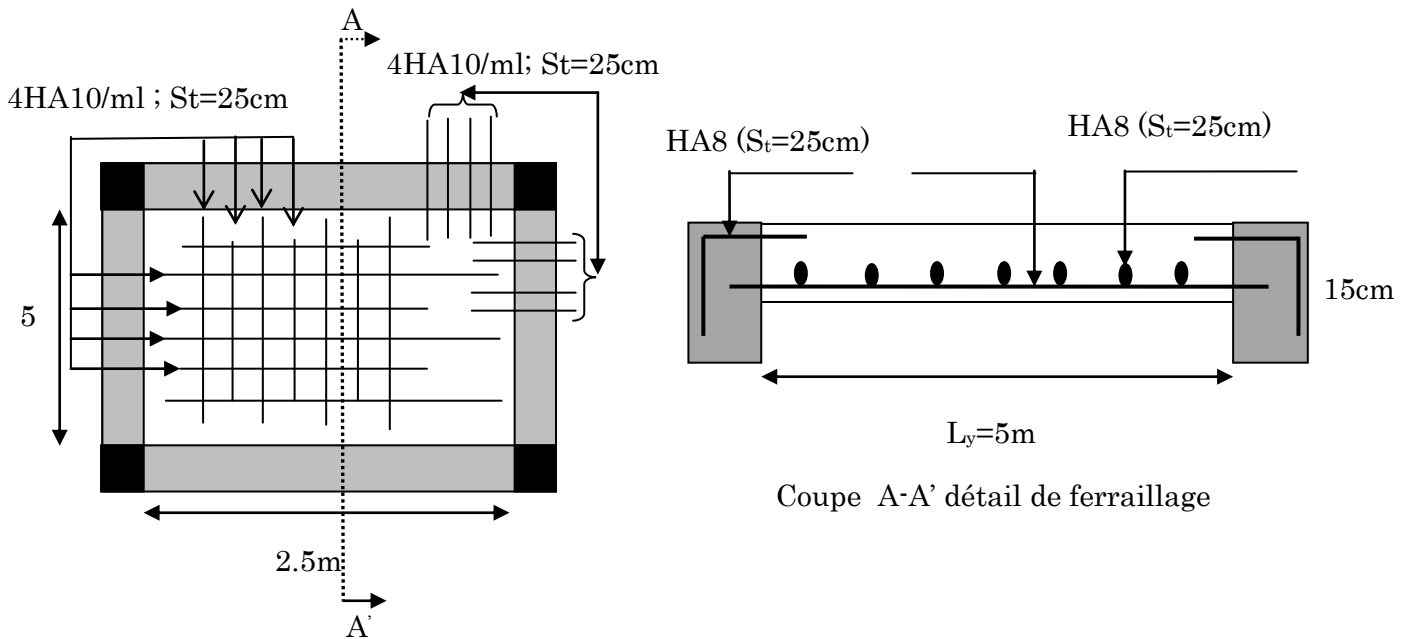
Schéma de ferrailage Dalle pleine sur quatre appuis.
